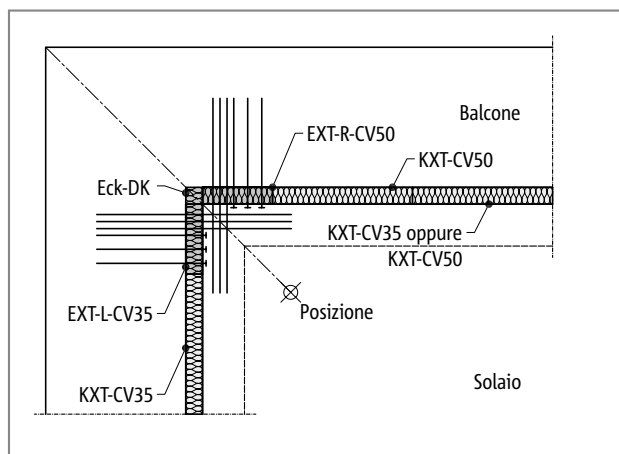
Schöck Isokorb® tipo EXT: balcone con angolo esterno a sbalzo (impiego EXT-L-CV35, EXT-R-CV50)
